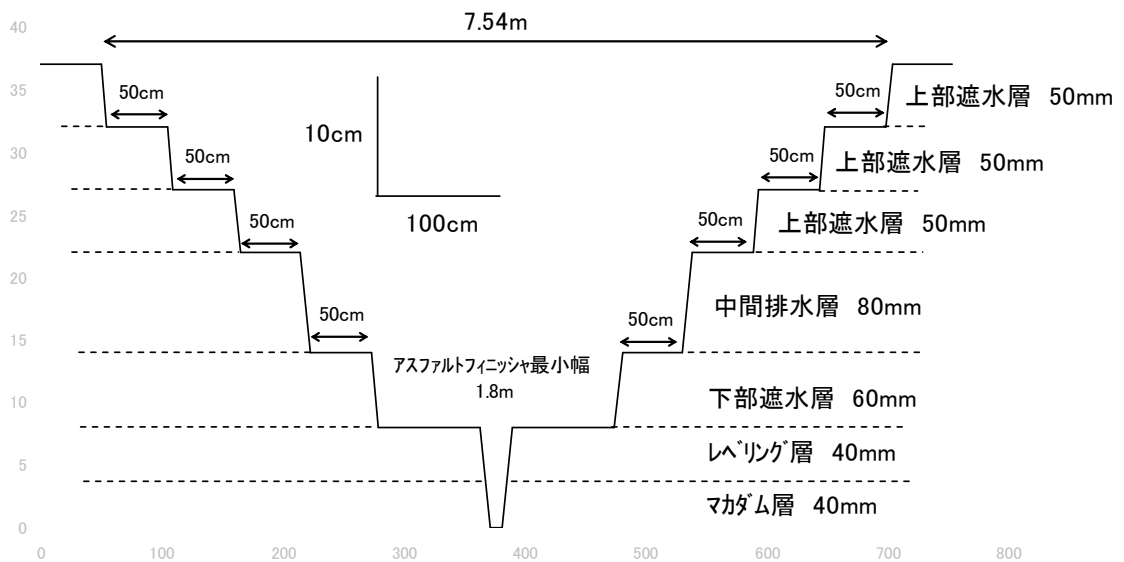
ひび割れを全て切削除去した場合の断面図
